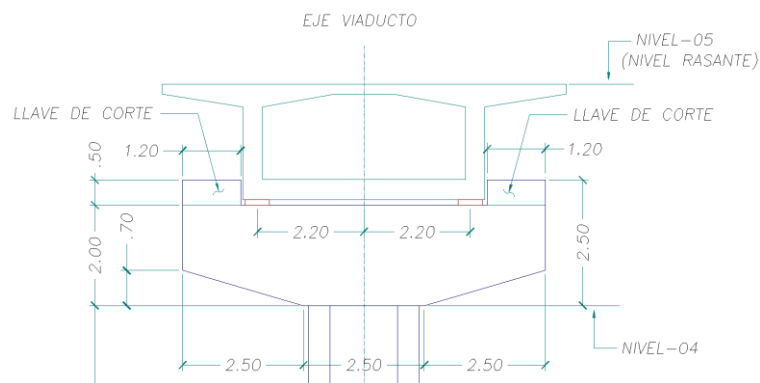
Sección transversal en Viga Cabezal en Pilar S48 –52
